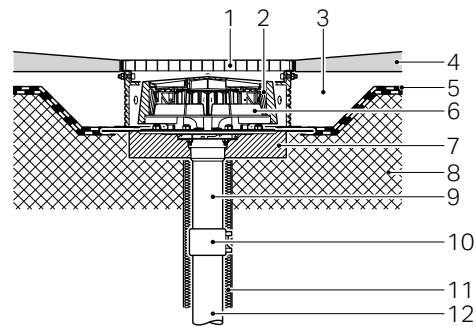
Aufbau Massivdach nicht gedämmt, mit Bitumen-Dachabdichtung, begehrbar
